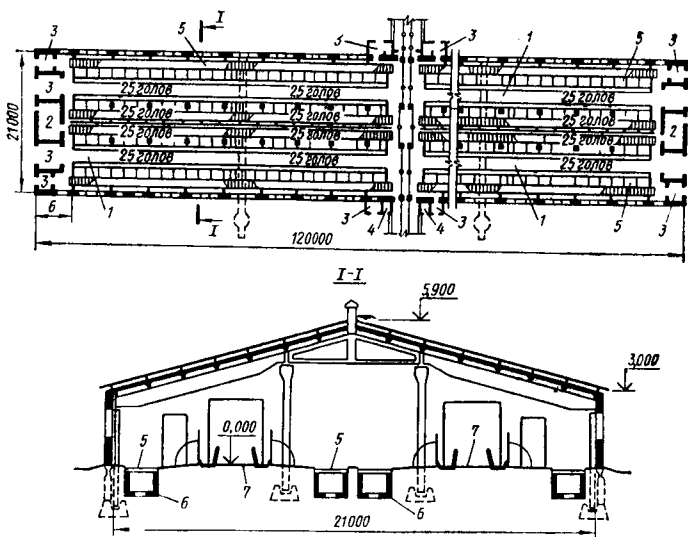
Главный чертёж коровника на 400 коров привязного содержания:
